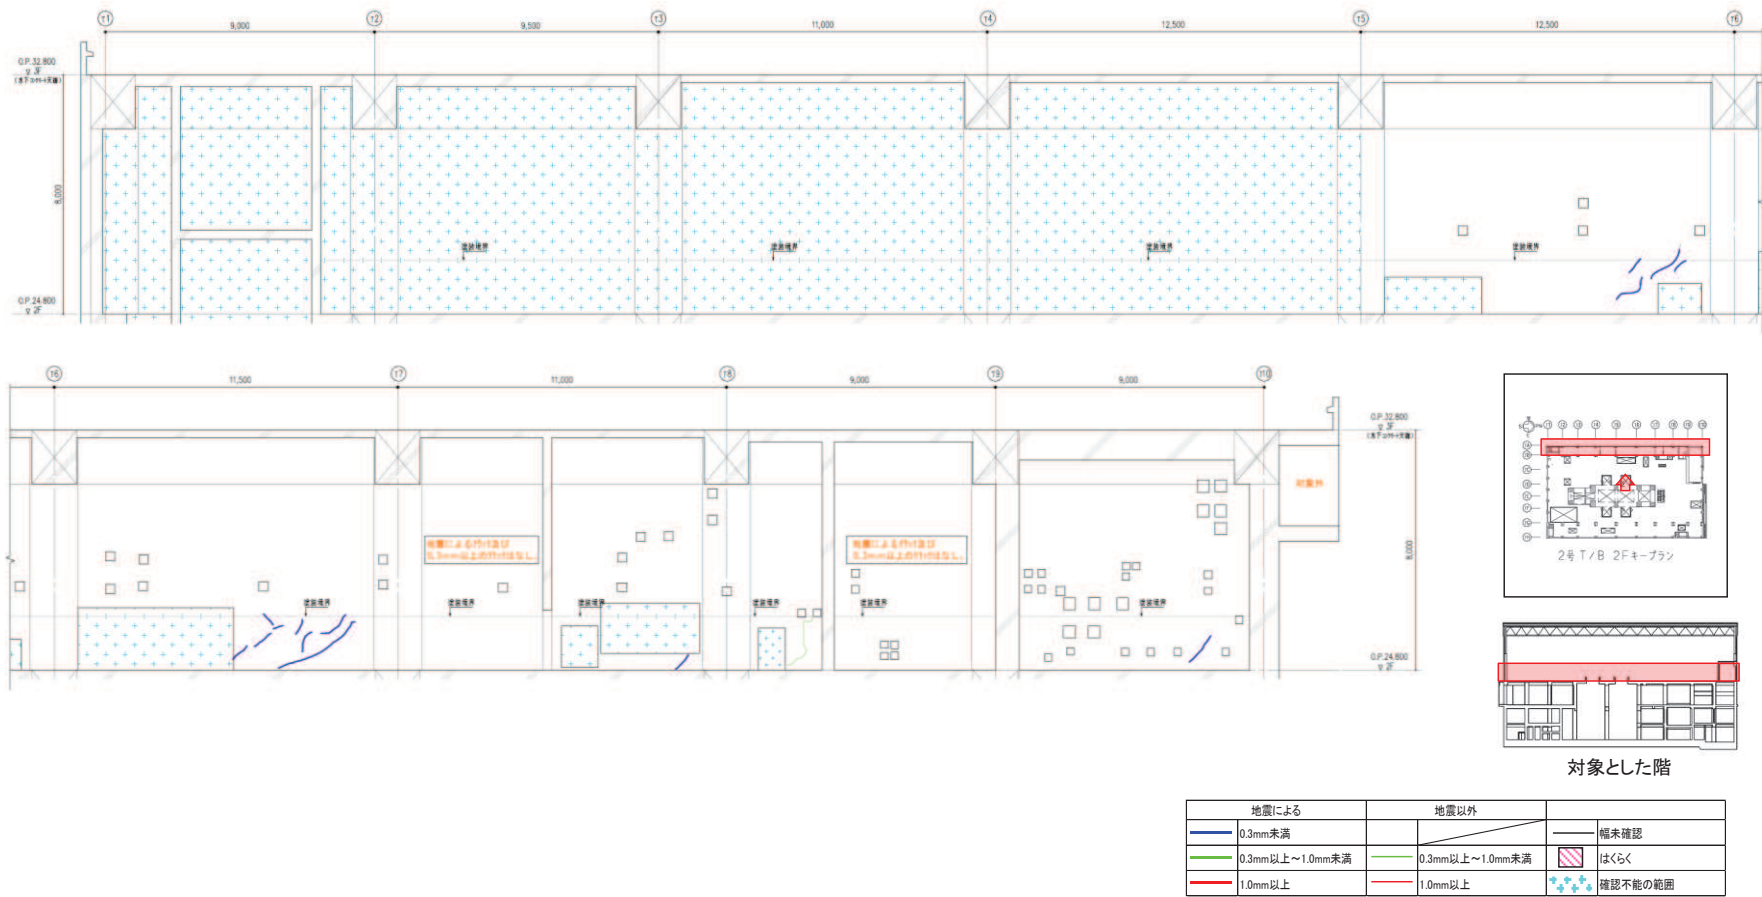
タービン建屋のひび割れ分布 耐震壁 (51) 2階 TA 通り
